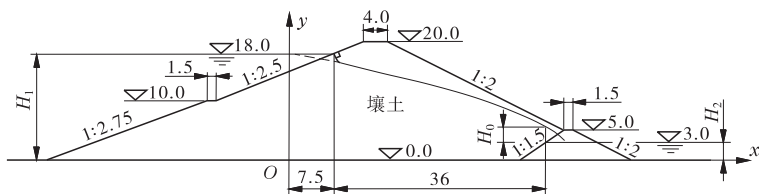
不透水地基上均质坝剖面图 (单位:m)
